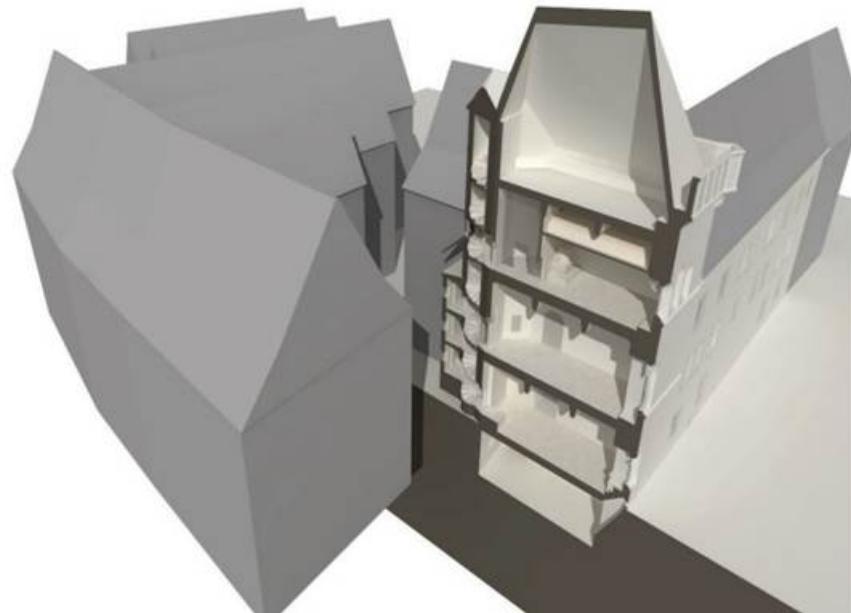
Дома «У звону» в Праге: разрез башни, винтовой лестницы и караульных помещений (<https://www.ghmp.cz/en/buildings/stone-bell-house/>)
